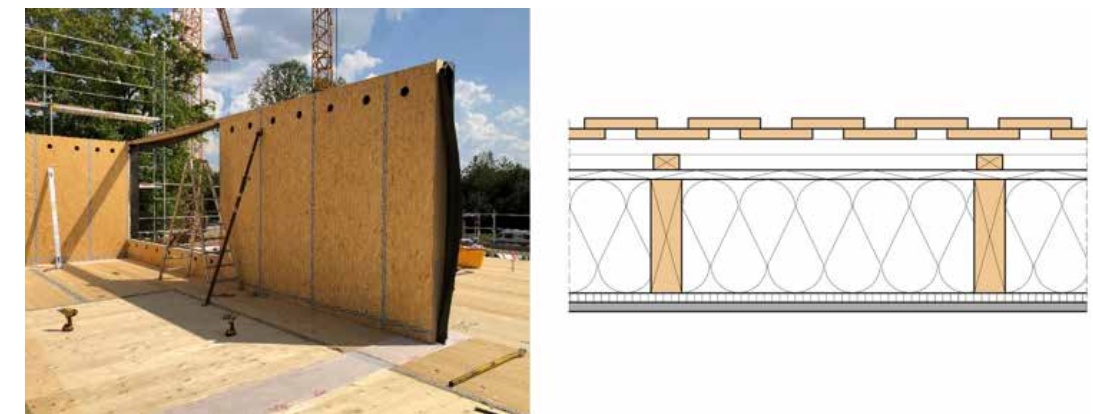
Holztafelbauwand als tragende Außenwand in Gebäudeklasse 3
